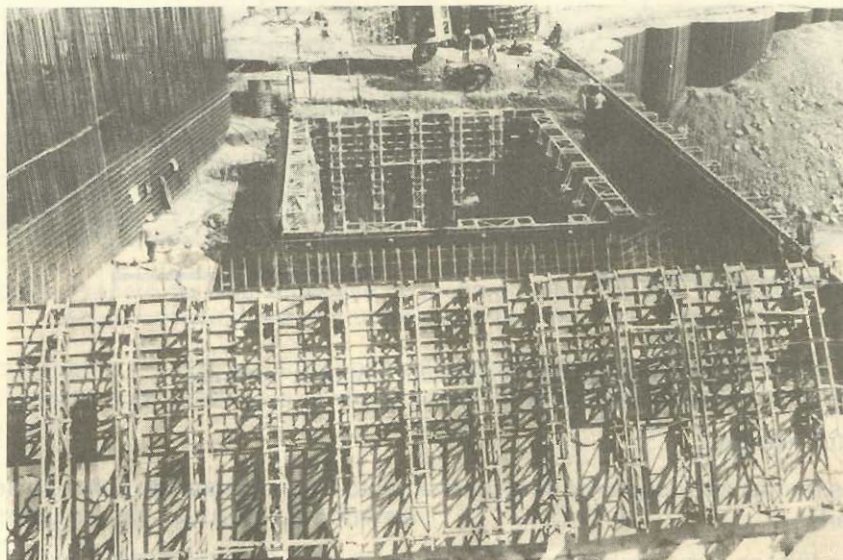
Fôrmas constituídas por painéis enrijecidos e sustentados por mísulas, em estruturas metálica, ancoradas ao concreto já solidificado
